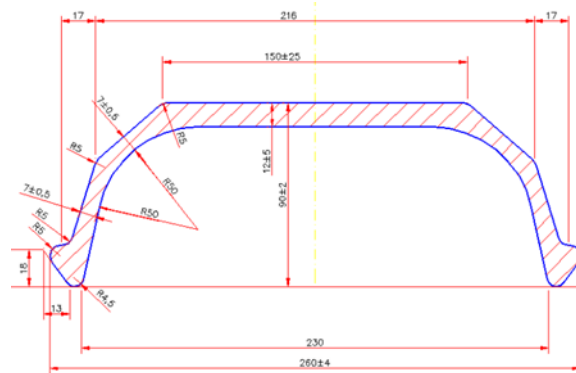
Perfil longitudinal do dormente de aço utilizado na EFVM conforme a norma UIC 865. (Vale SA, 2013).
